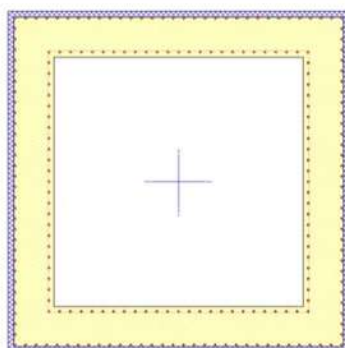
s Configuración del armado de la pila del Puente C terminado.
